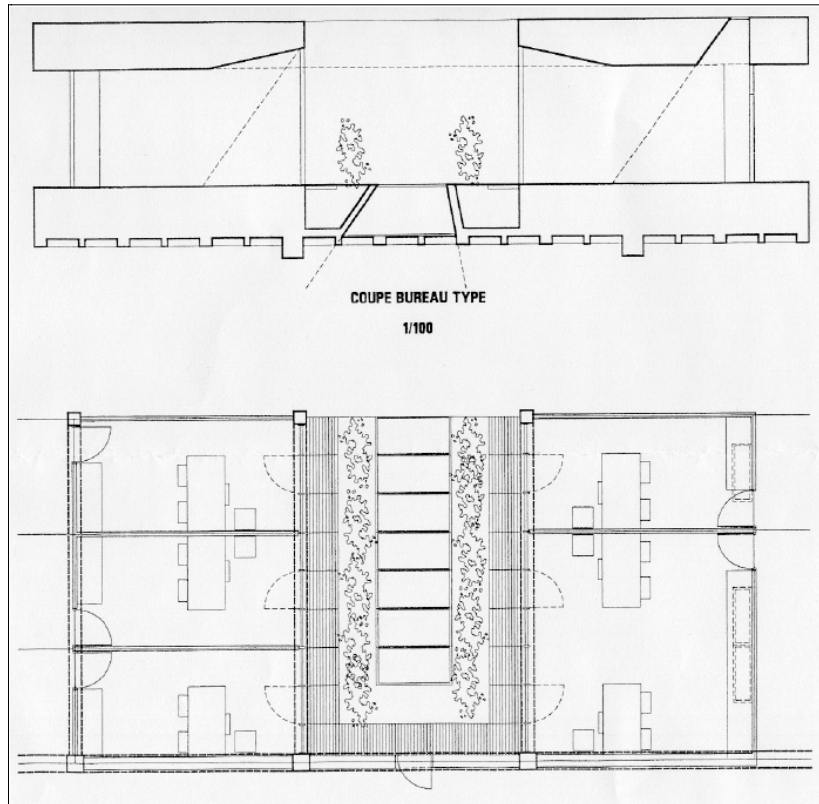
Plan et coupe sur le bureau type montrant le puits de lumière
